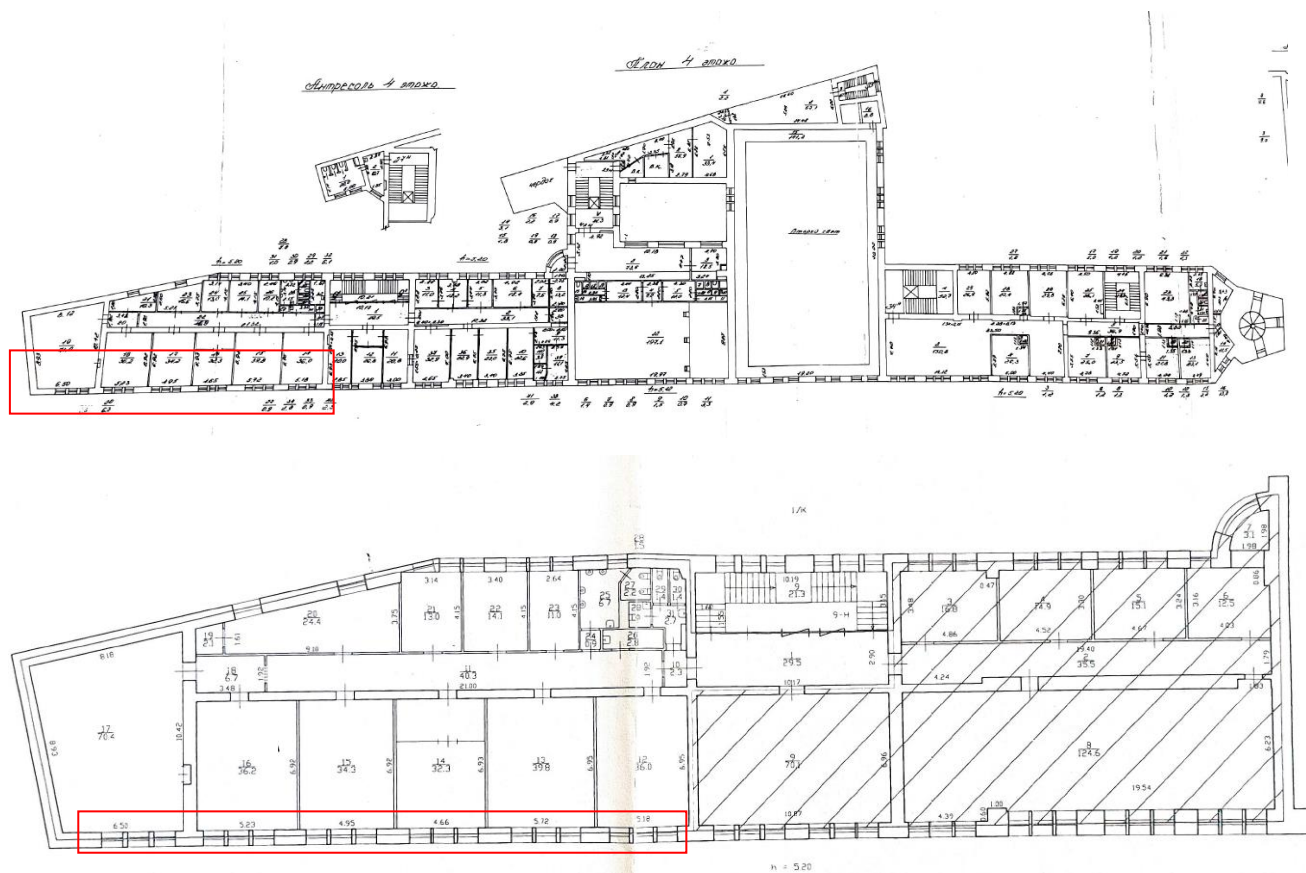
Планы-схемы 4 этажа. Границы проектирования.
